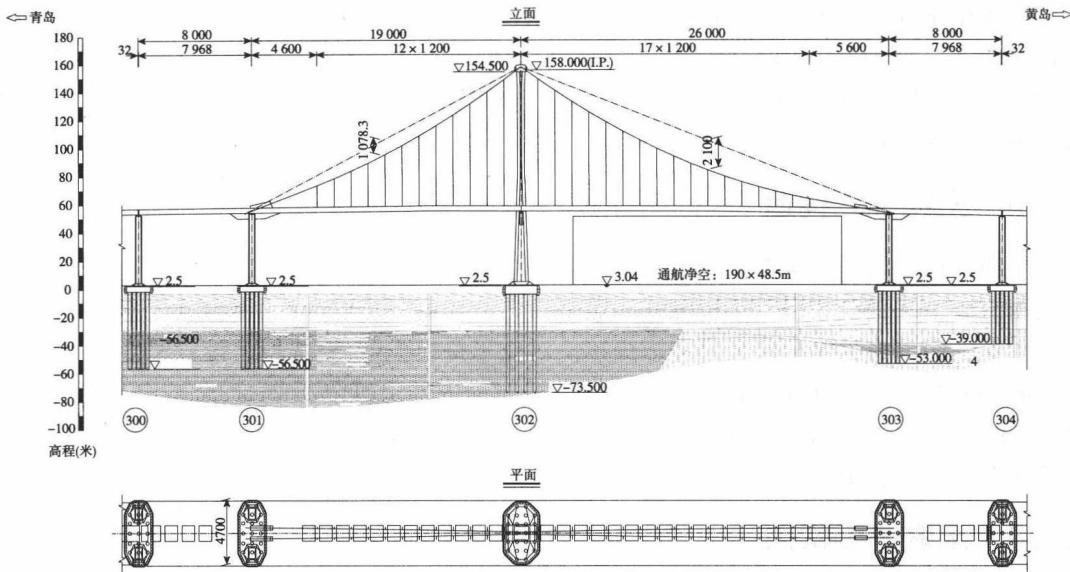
大沽河航道桥桥型布置(尺寸单位:cm)
